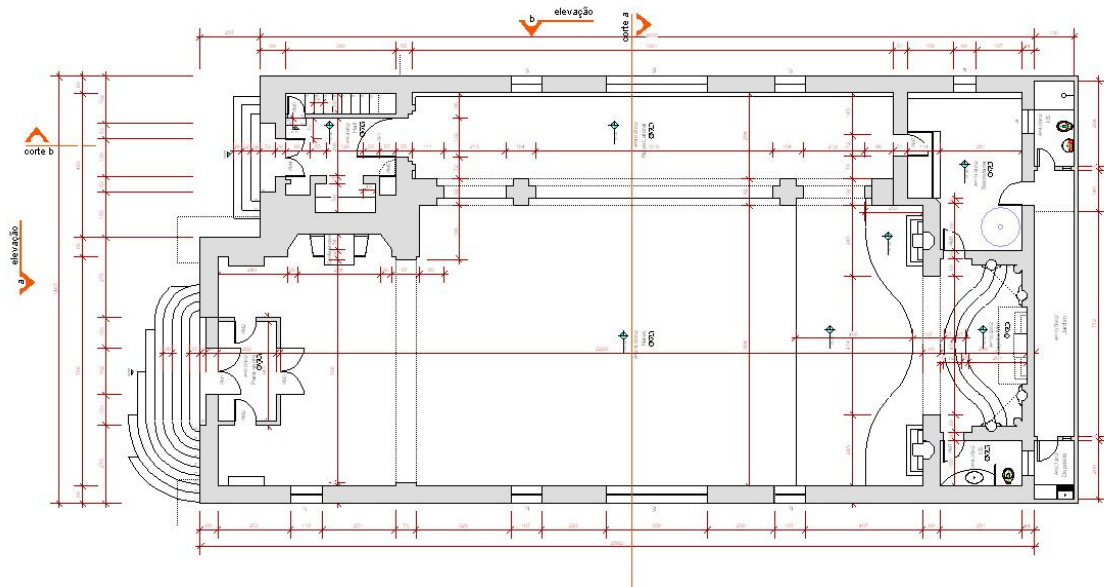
e: Igreja de Nossa Senhora do Rosário de São Benedito – croqui: planta da nave e presbitério.
